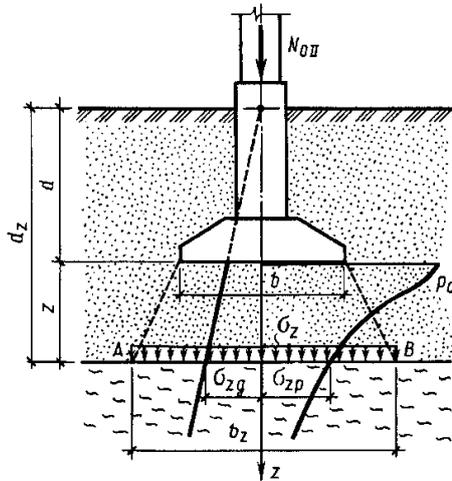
Расчетная схема к проверке давления на подстилающий слой слабого грунта
